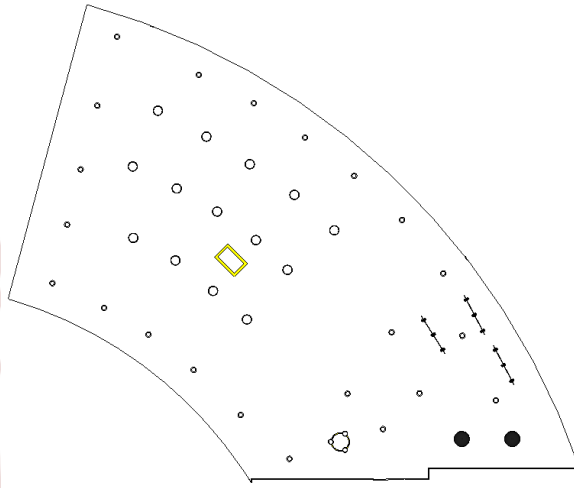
Alternatif 2 Rencana *Ceiling Lobby
